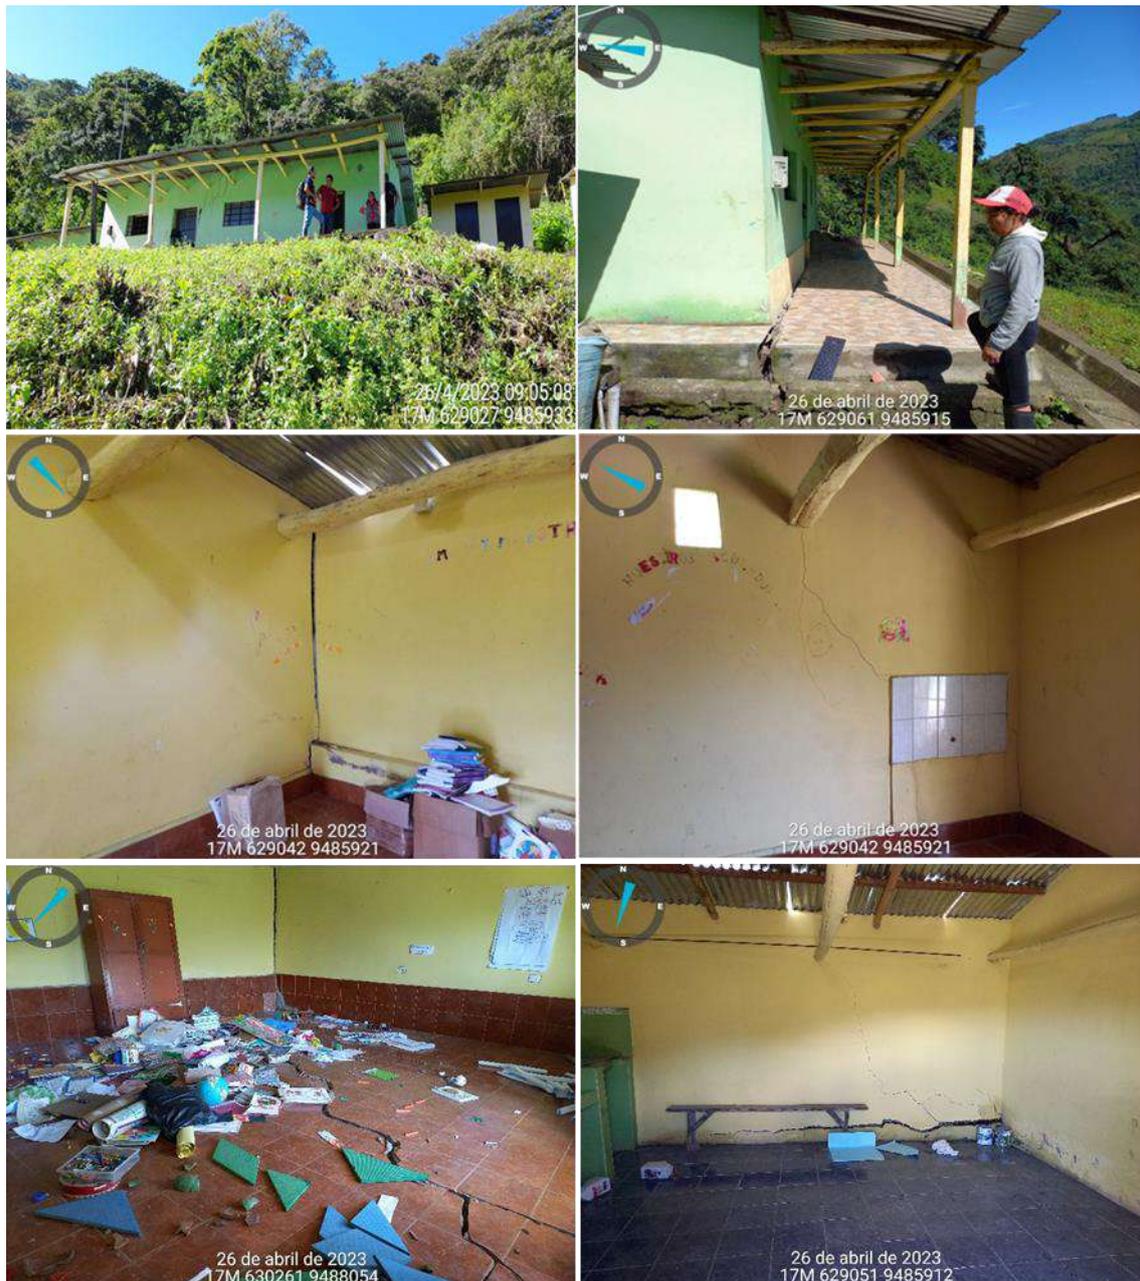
Grietas en el suelo y paredes de la institución educativa Los Girasoles que se encuentra asentada sobre la ladera del poblado Israel, las dos primeras imágenes muestran grietas en la pared de la fachada y desplazamiento de la vereda, el resto de las imágenes evidencian grietas en el piso y paredes de las aulas
